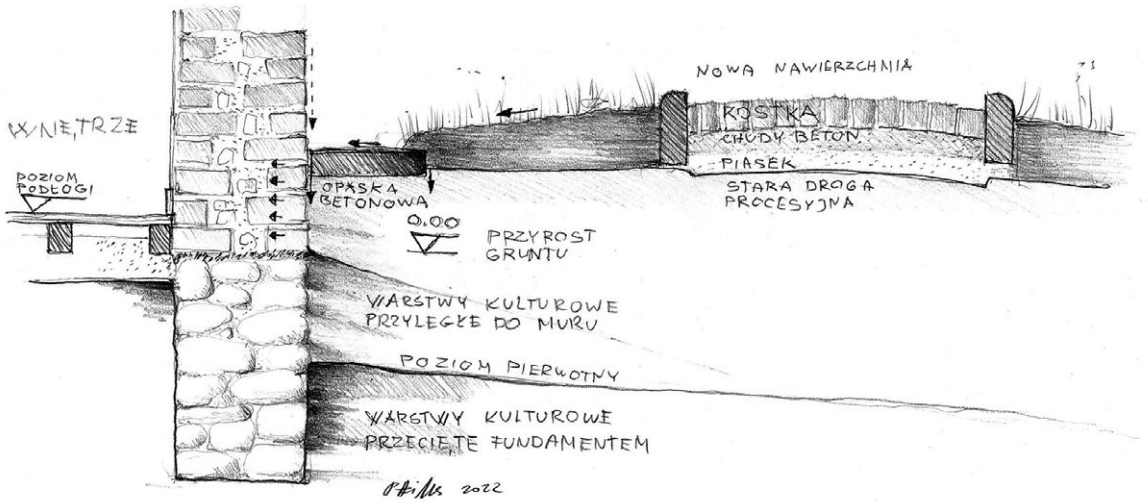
Beispiel für ein erhöhtes Geländeniveau um das Gebäude herum mit einer fehlerhaften Ableitung des Regenwassers, was zu einer Durchfeuchtung der Erdgeschossmauern führt. Eine neue Straße mit Betonunterbau und hohen Bordsteinen blockiert den Wasserabfluss von der direkt an die Gebäudewände angrenzenden Bodenfläche vollständig.
